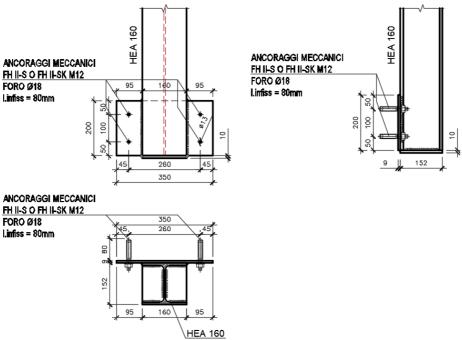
Dettaglio del collegamento superiore HEA160 barriera lato mare
